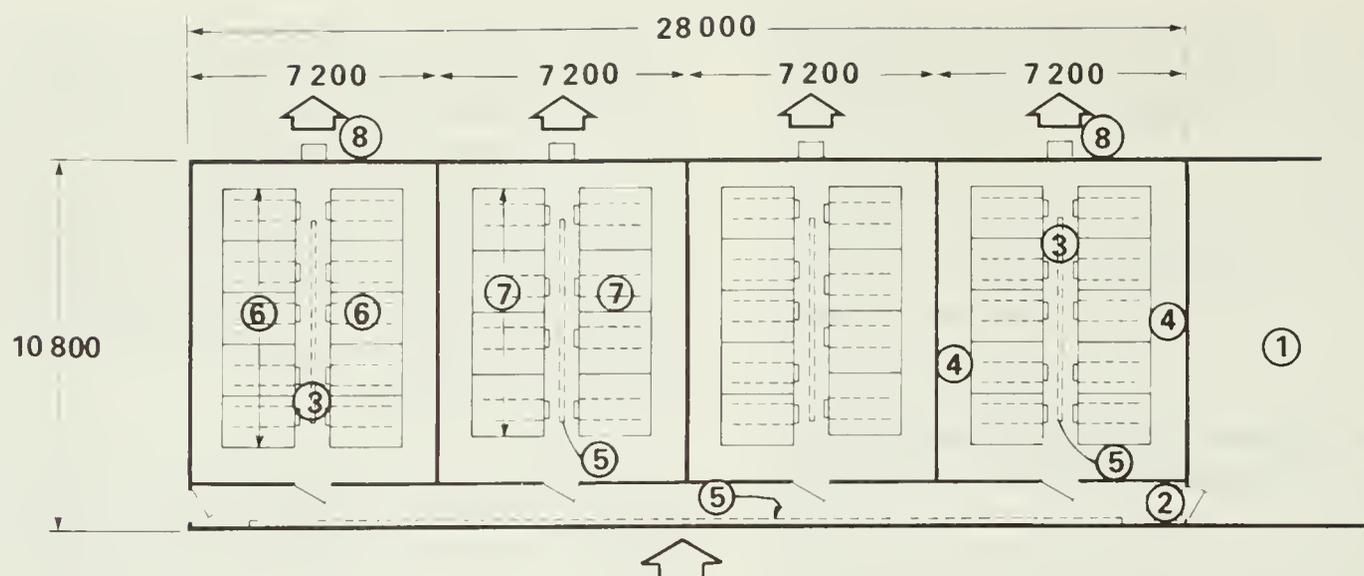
Plan d'une section de mise bas à quatre pièces pour un troupeau de 100 truies, plan à entrée petite
